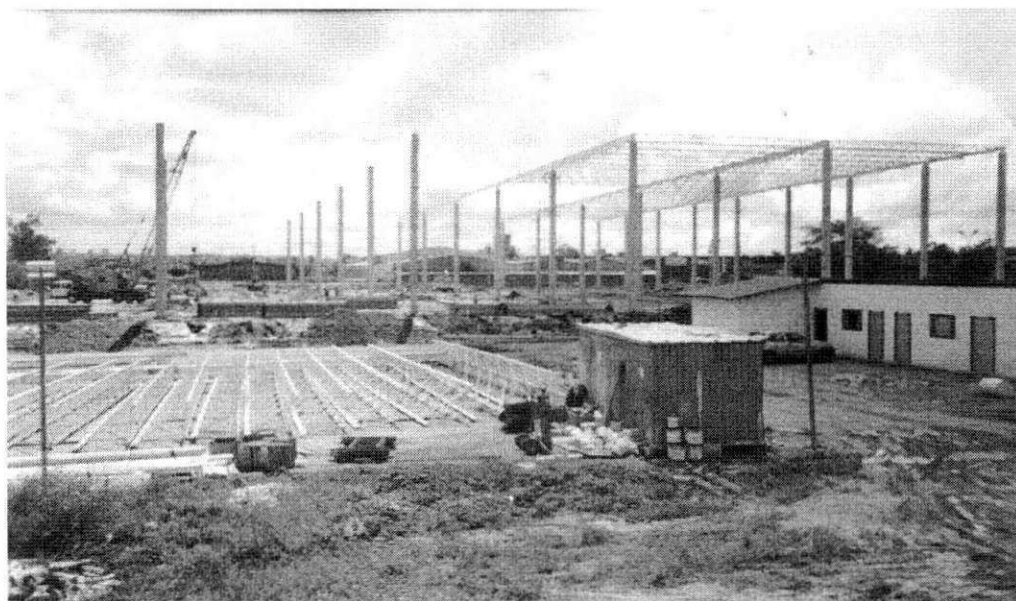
Canteiro de Obras (montagem e armazenamento de estrutura metálica)
